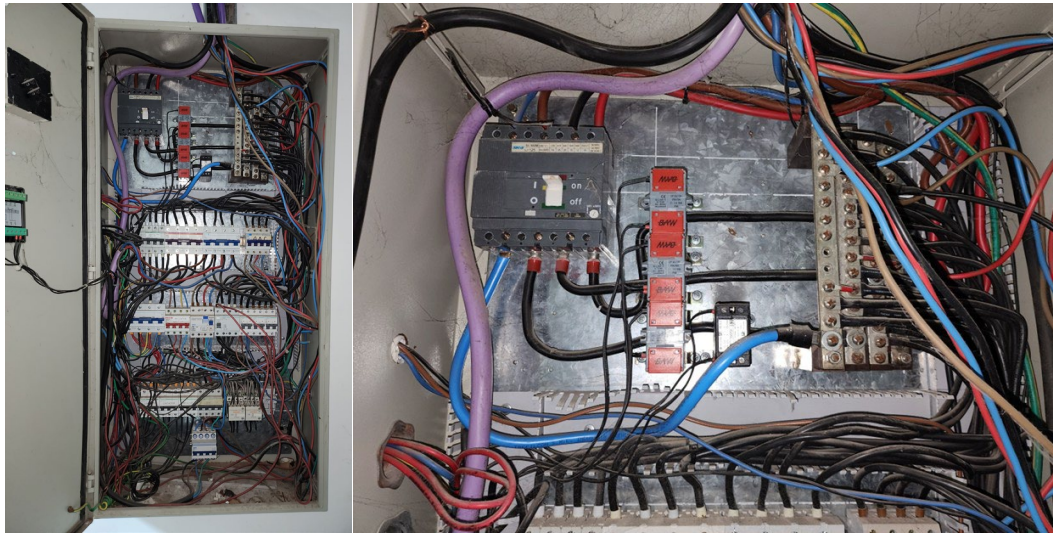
Tablero general de baja tensión (TGBT1) ubicado en planta baja, y que distribuye hacia planta baja, primer piso, segundo y el depósito (tercer piso).
